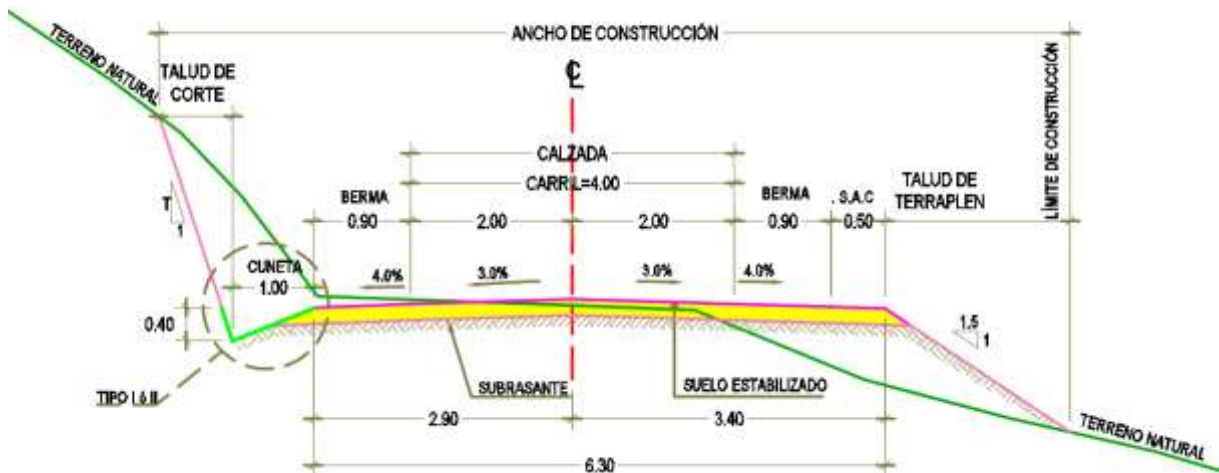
Sección típica a media ladera. Fuente: Planos de Secciones Típicas.
